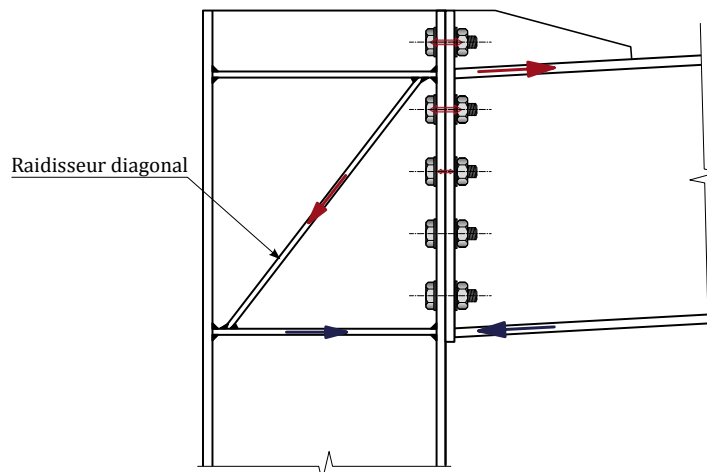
Exemple d'assemblage poutre-poteau avec raidisseur diagonal
